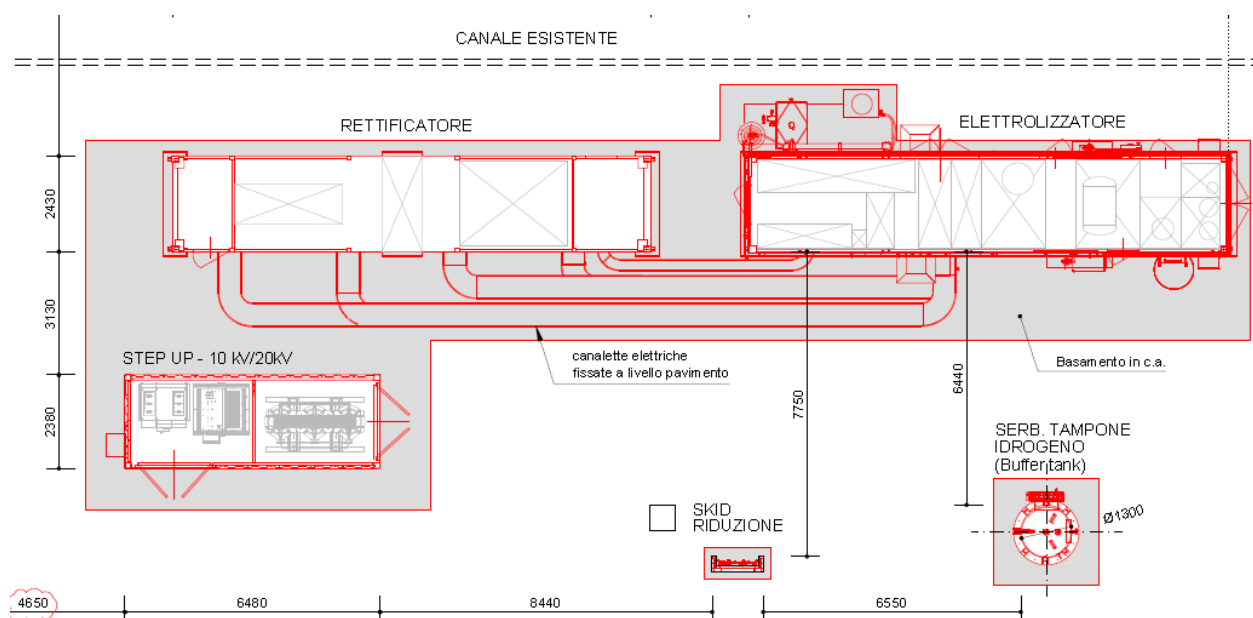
Layout di progetto – Dettaglio Zona 1 di intervento
